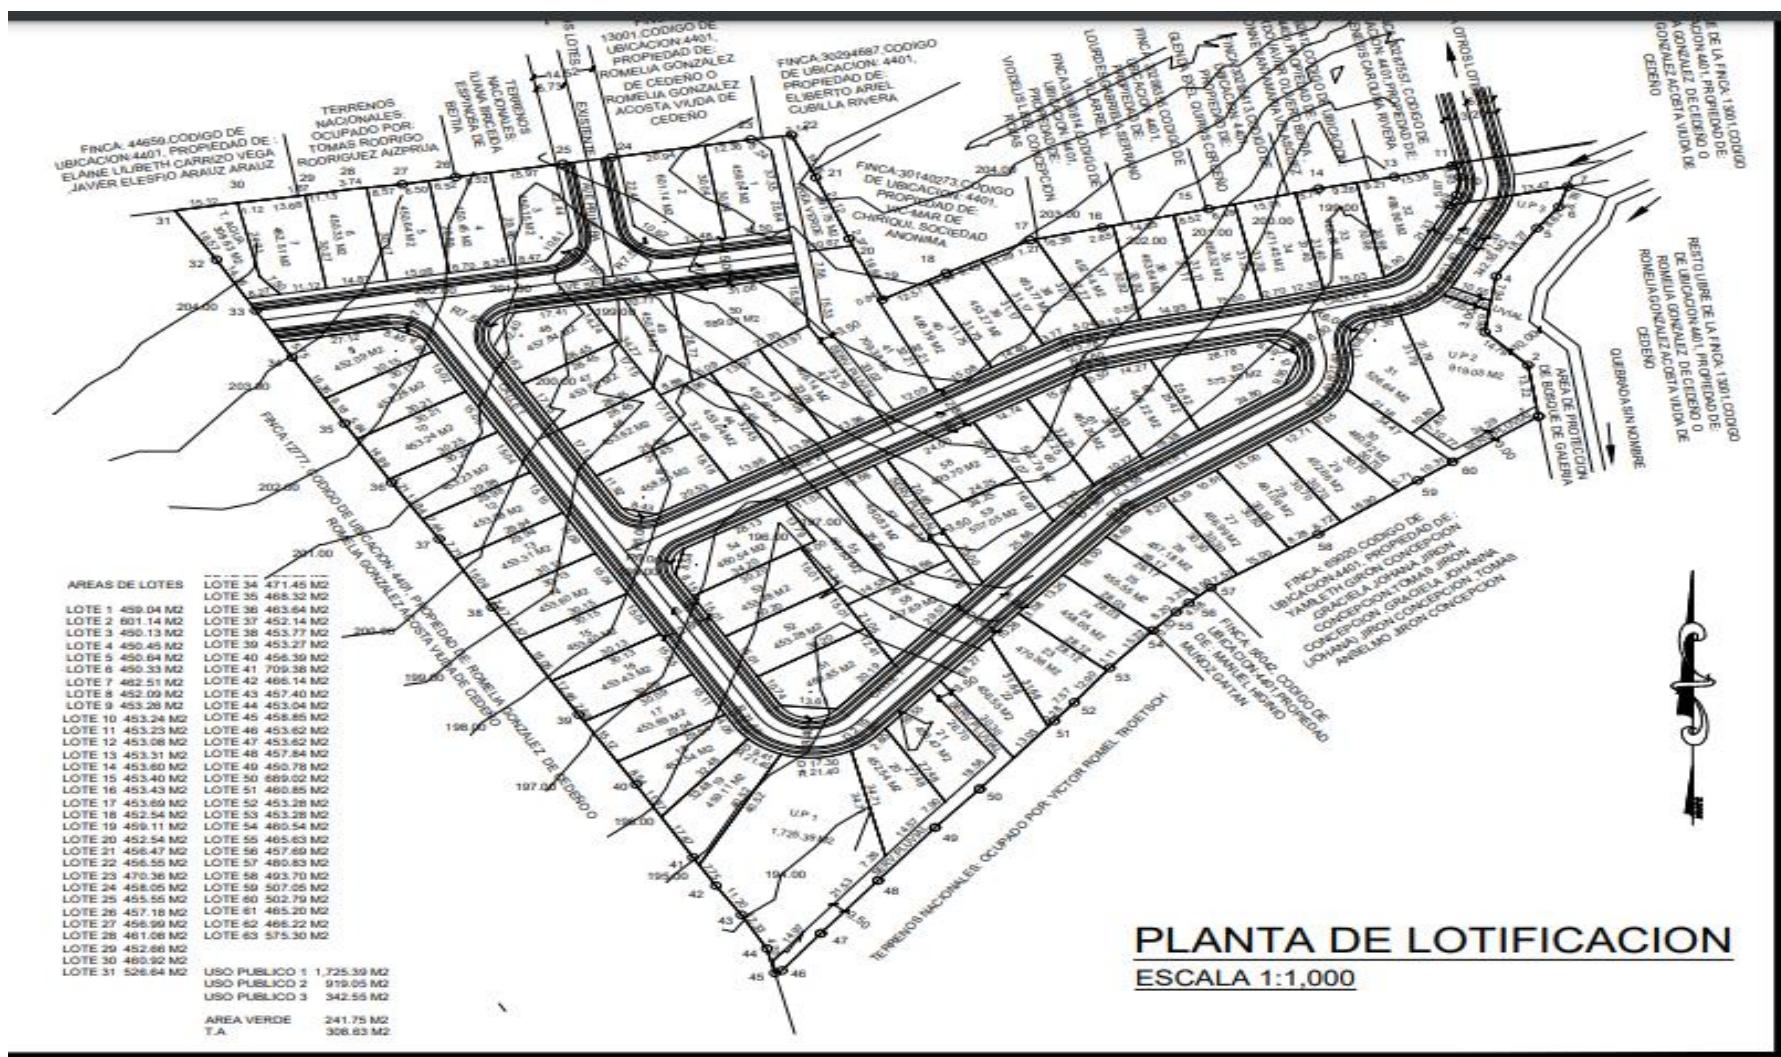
Planta del “Residencial Virginia VII”. Fuente: Planos de Anteproyecto
